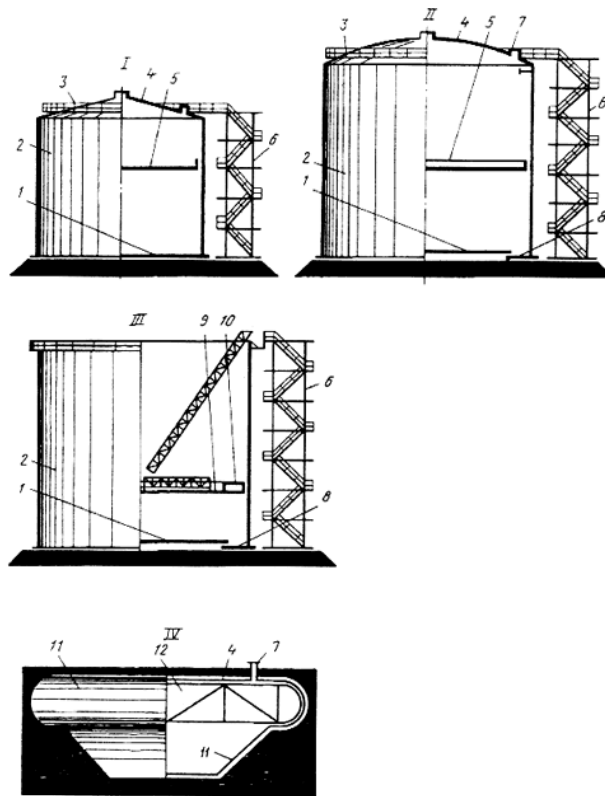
Конструктивные схемы рулонизируемых резервуаров: тип I - резервуары малого и среднего объема с коническими крышами; тип II - резервуары большого объема со сферическими крышами; тип III - резервуары с плавающими крышами; тип IV - резервуары траншейного типа для подземного хранения продукта; 1 - днище; 2 - стенка резервуара; 3 - рабочая площадка; 4 - крыша; 5 - понтон; 6 - лестница; 7 - элемент оборудования; 8 -окраинный элемент; 9 - плавающая крыша; 10 - короб плавающей крыши; 11 - оболочка; 12 - ферма Автоматическую сварку полотнища производят на специальном двухъярусном механизированном стане (рис.2), по мере сварки полотнище резервуара сворачивается в рулон, подобный рулону толя (обязательно габаритный).
